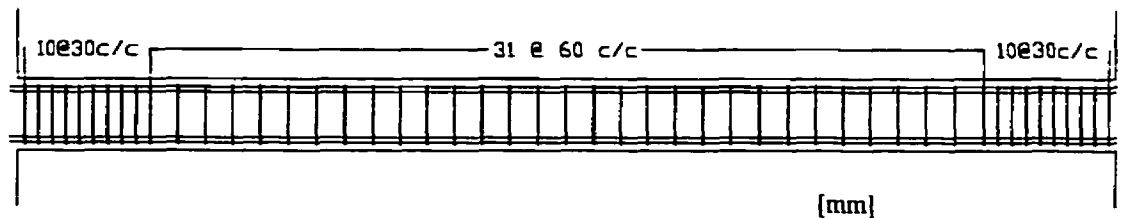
Disposition de l'armature transversale dans les poutres à l'étage.
